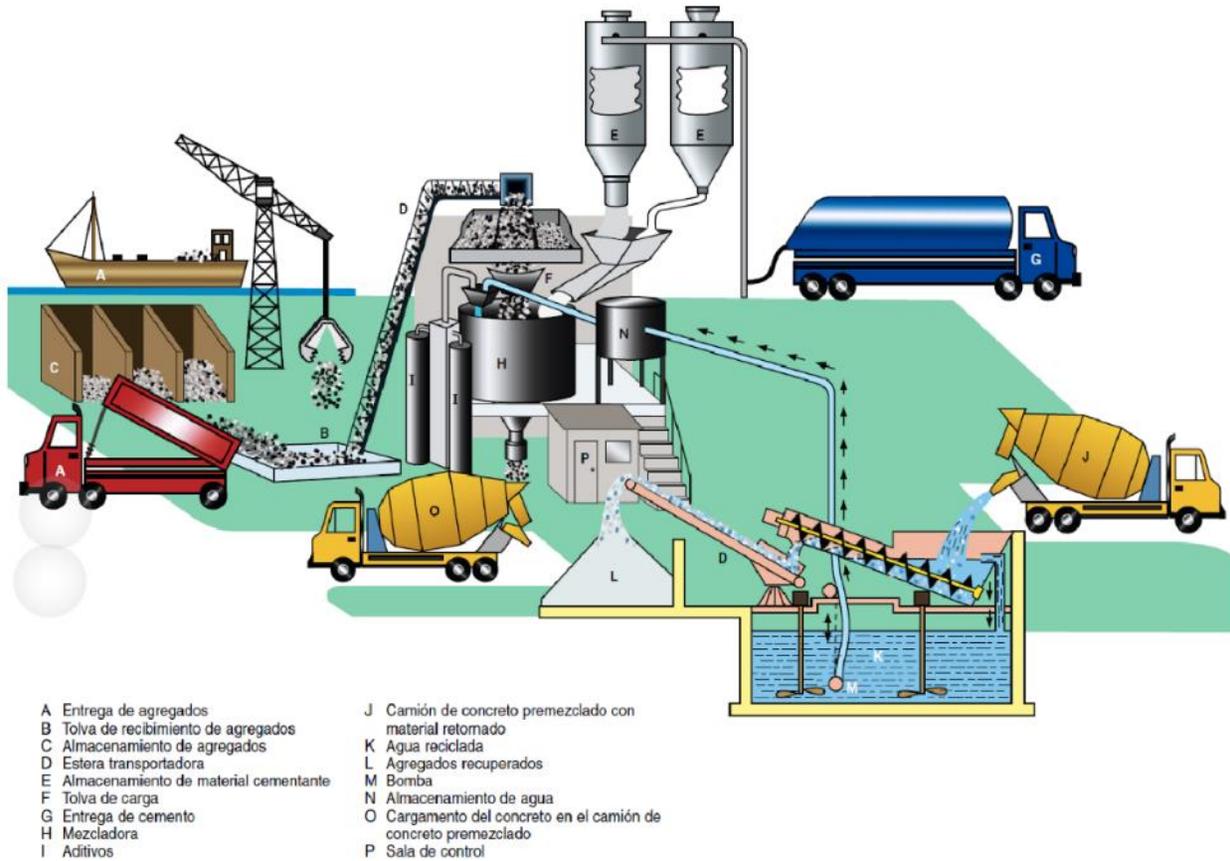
Etapas de la producción del concreto en una planta mezcladora
